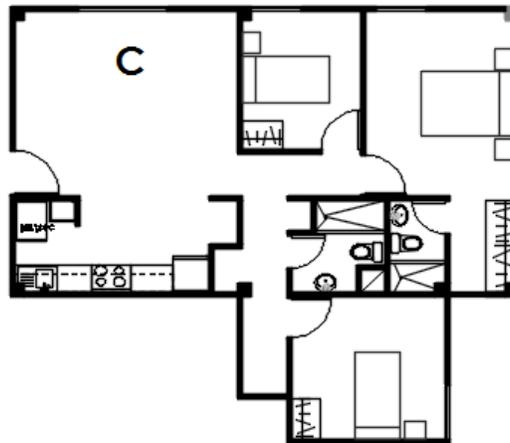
Planta arquitectónica departamento C master conjunto residencial “Praderas de Bemani”.
